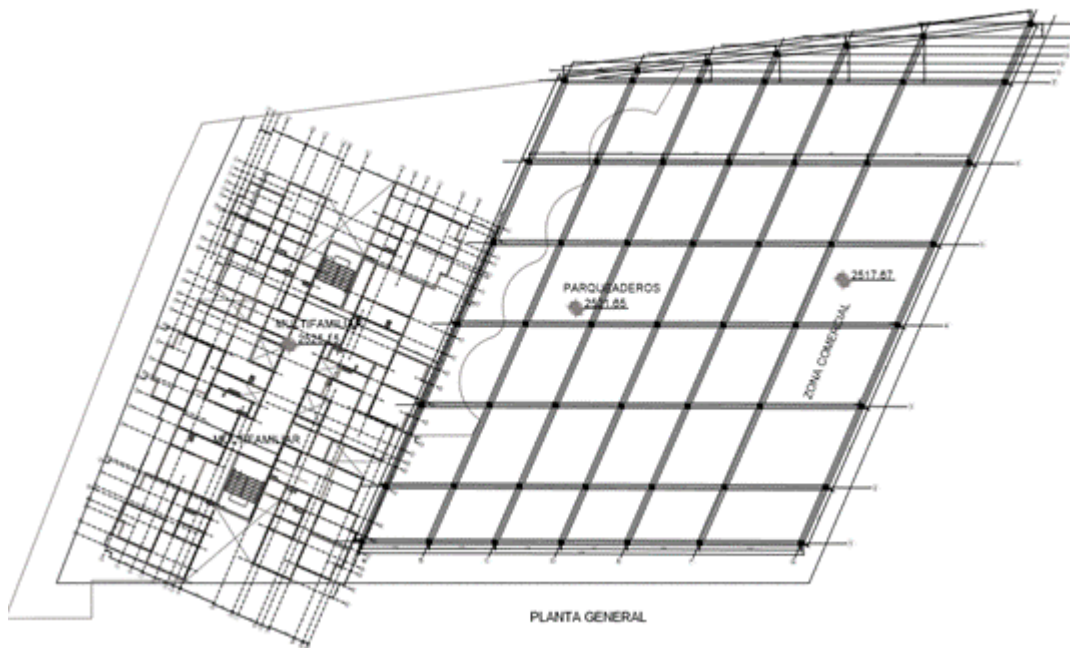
PLANTA GENERAL DEL EDIFICIO. FUENTE: CONSTRUCTORA
